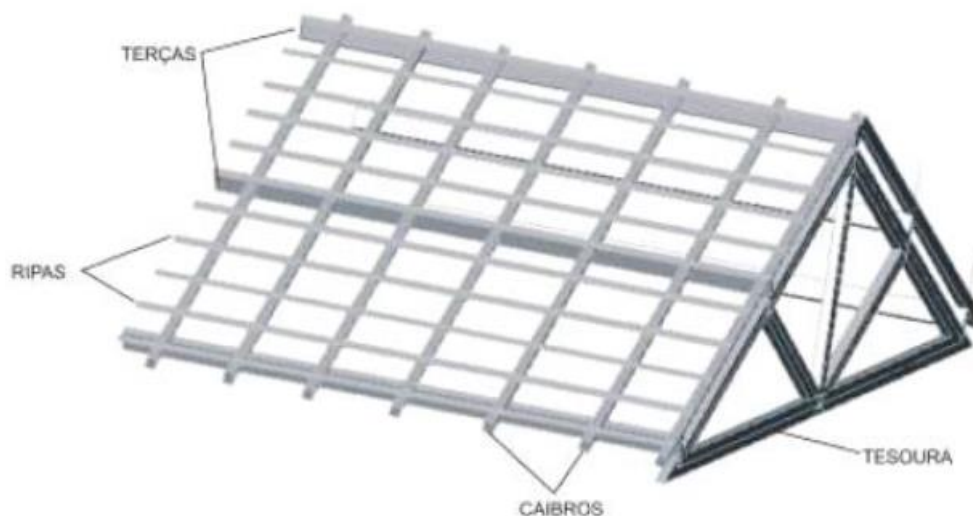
Elementos que Compõem a Estrutura da Cobertura
